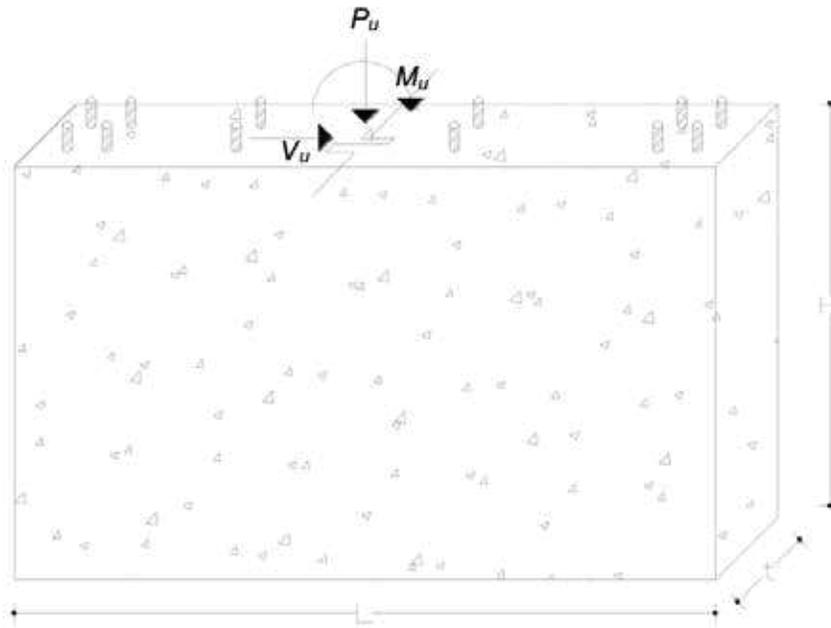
Elementos mecánicos actuantes en un muro de concreto reforzado. Fuente: Elaboración propia
